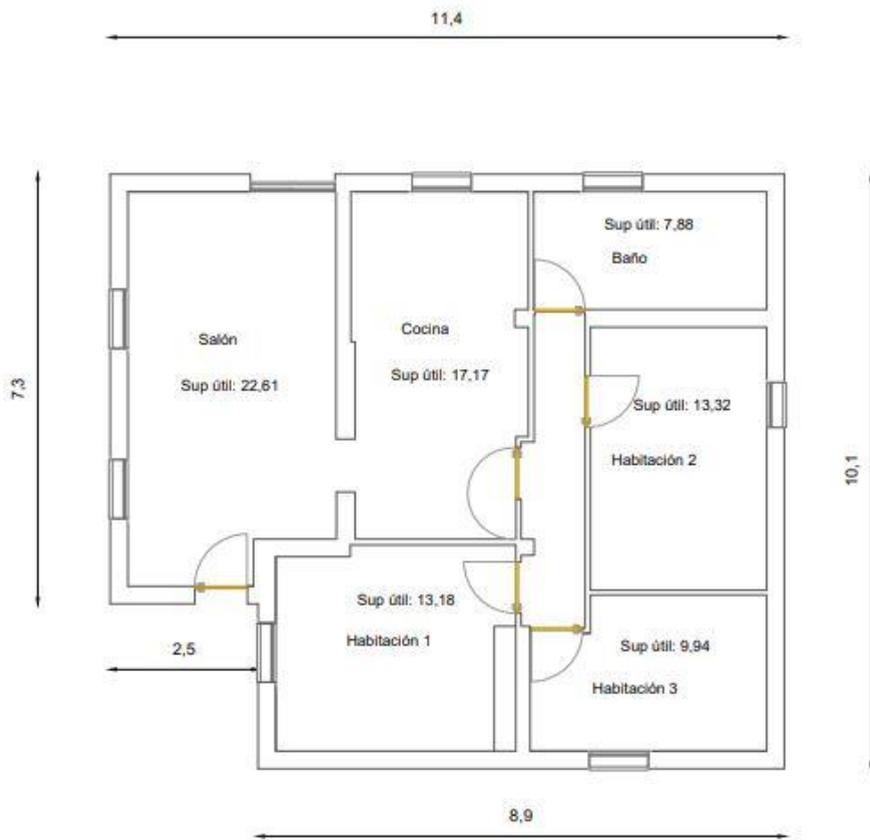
Planta cotas y superficies PB. Fuente: Elaboración propia
